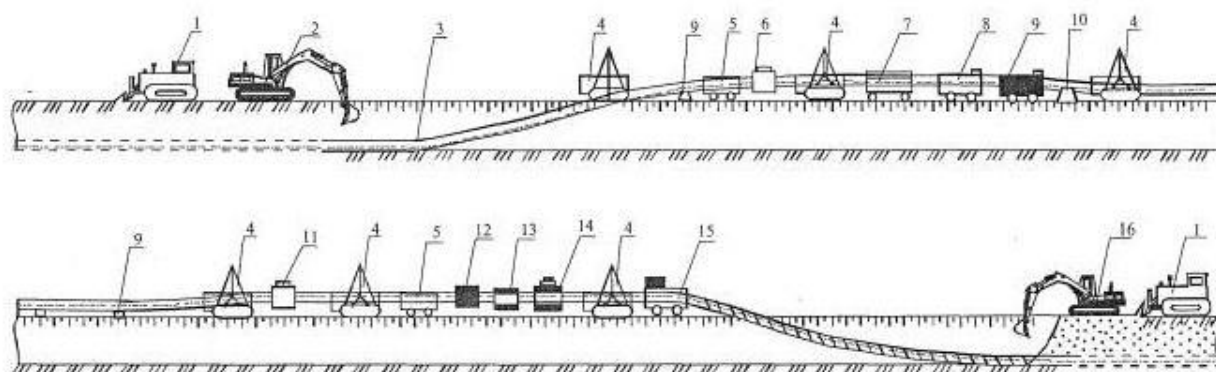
Схема капитального ремонта трубопровода на берме траншеи
